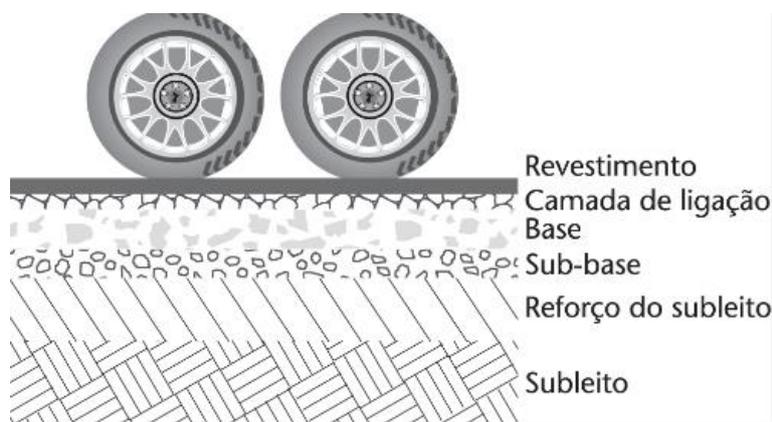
Disposição das camadas genéricas de pavimentos rodoviários.
